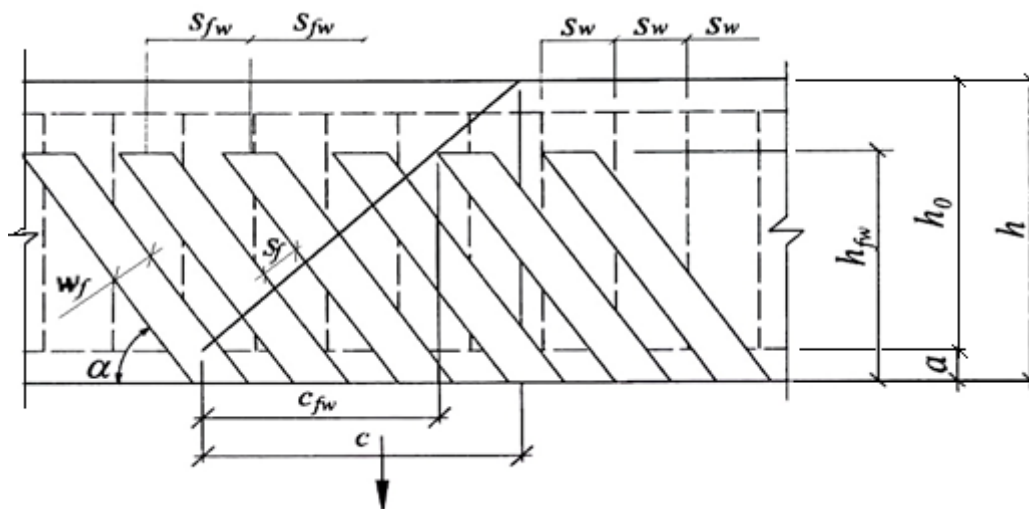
Схема усилий при расчете изгибаемых элементов с внешним армированием из композитных материалов по наклонному сечению на действие поперечных сил.
